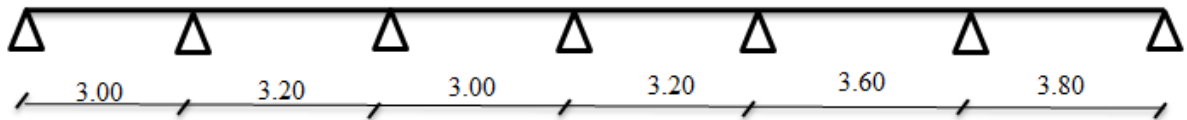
Poutrelle type 03 (Plancher RDC et étages courants)
